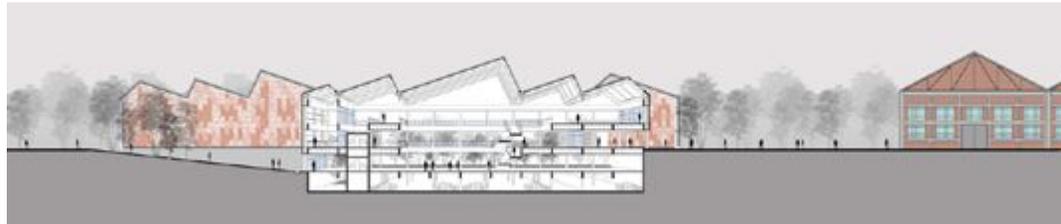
Corte longitudinal. Autoría: Elaboración propia
